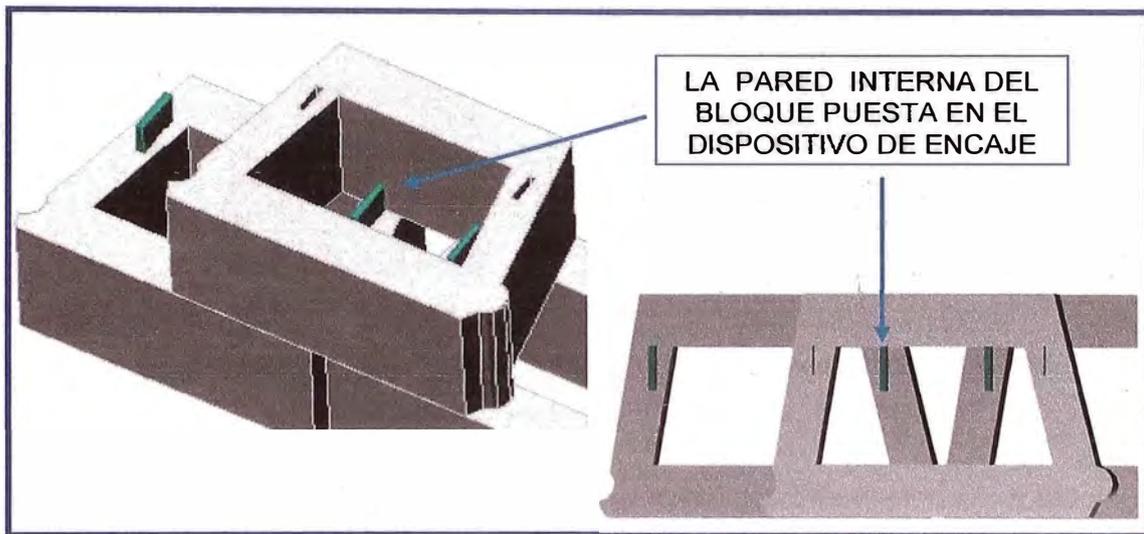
Muro de suelo reforzado – Colocación de Bloques de Concreto.
